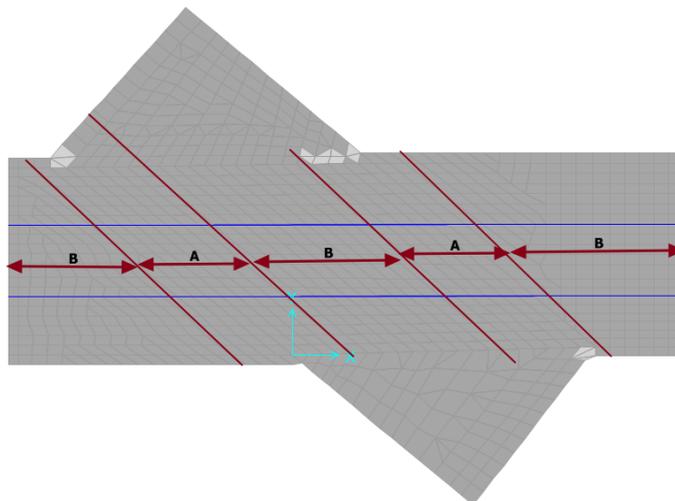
Individuazione dell'infittimento di armatura trasversale
